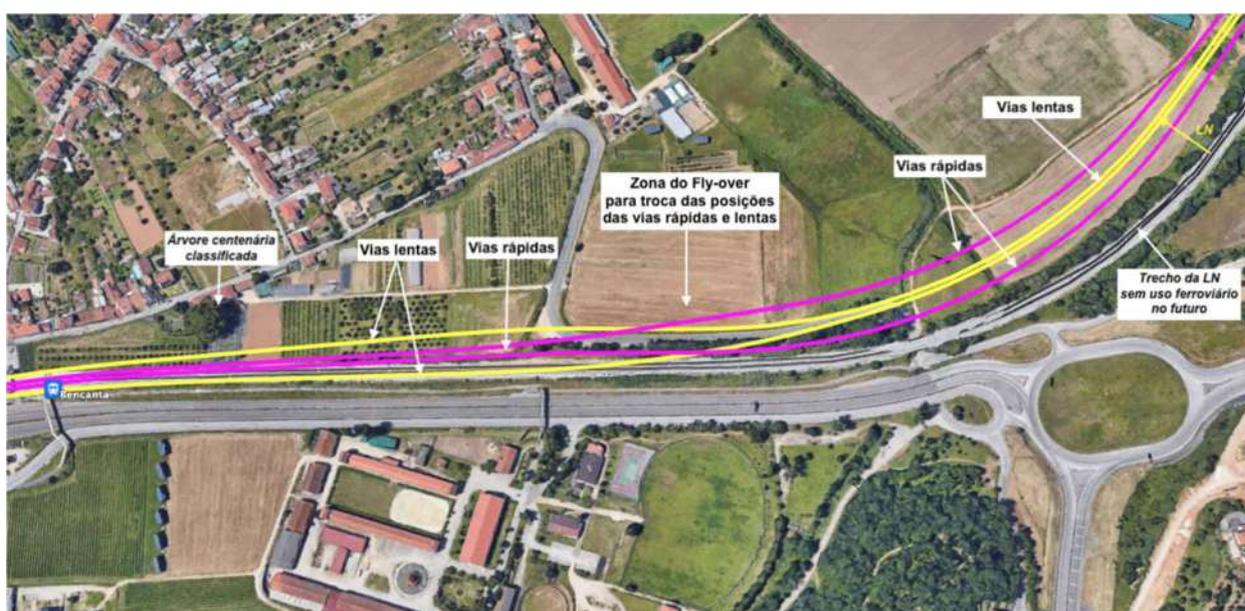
Zona do Fly-over entre Bencanta e Coimbra B
